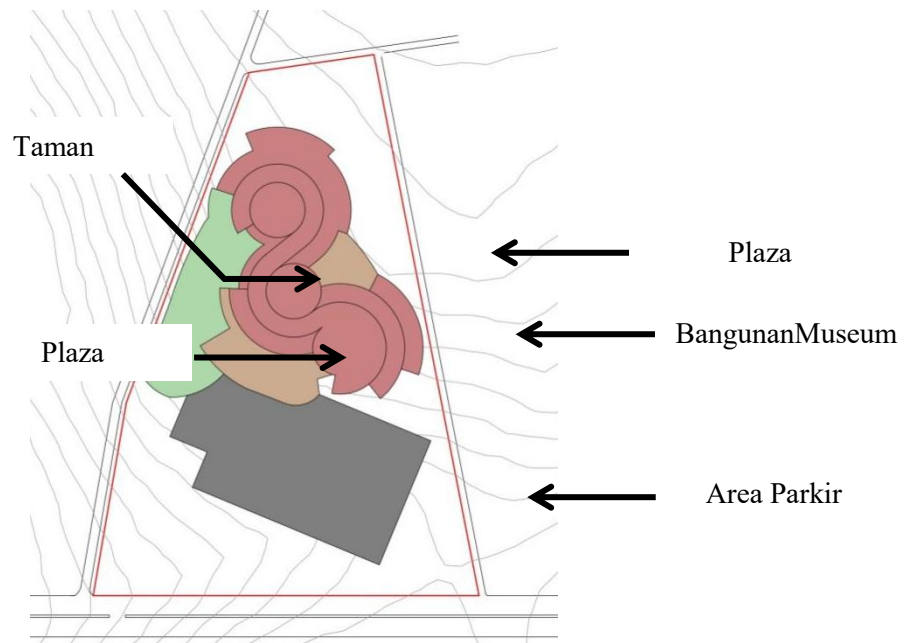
Konsep Konfigurasi Geometrik Massa Bangunan
